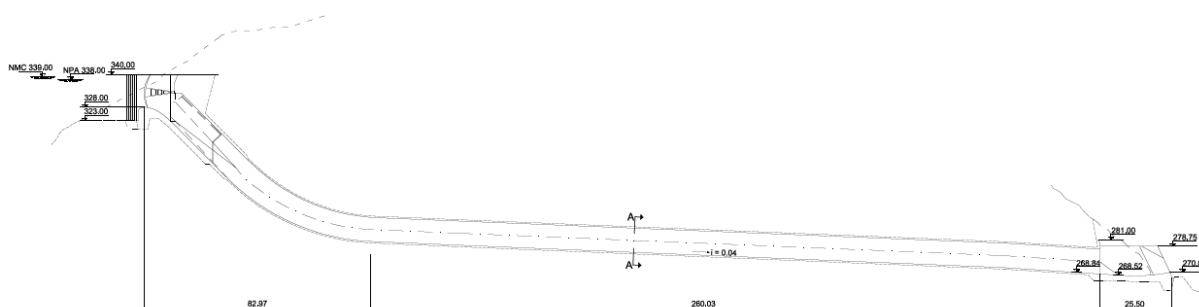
Perfil longitudinal do descarregador de cheias DC2 da barragem do Alto Lindoso. Fonte: [EDP (2018)].
